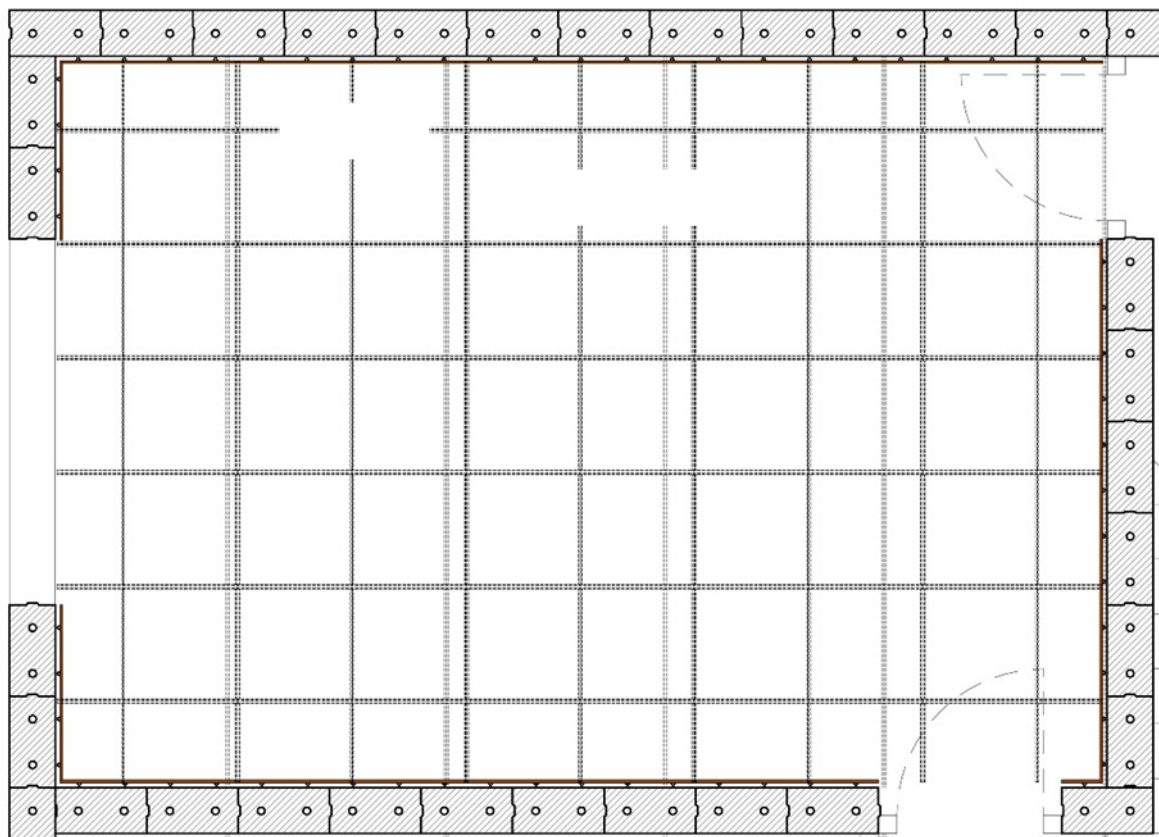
Grundriss im EG /Ausbau Decken-Unterkonstruktion
